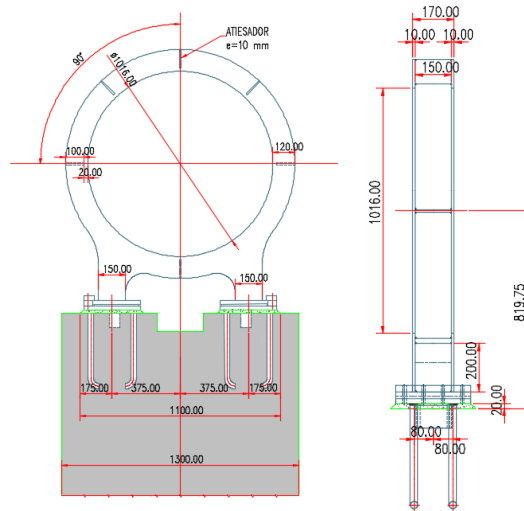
Elevación y perfil de abrazadera típica unida al bloque de apoyo
